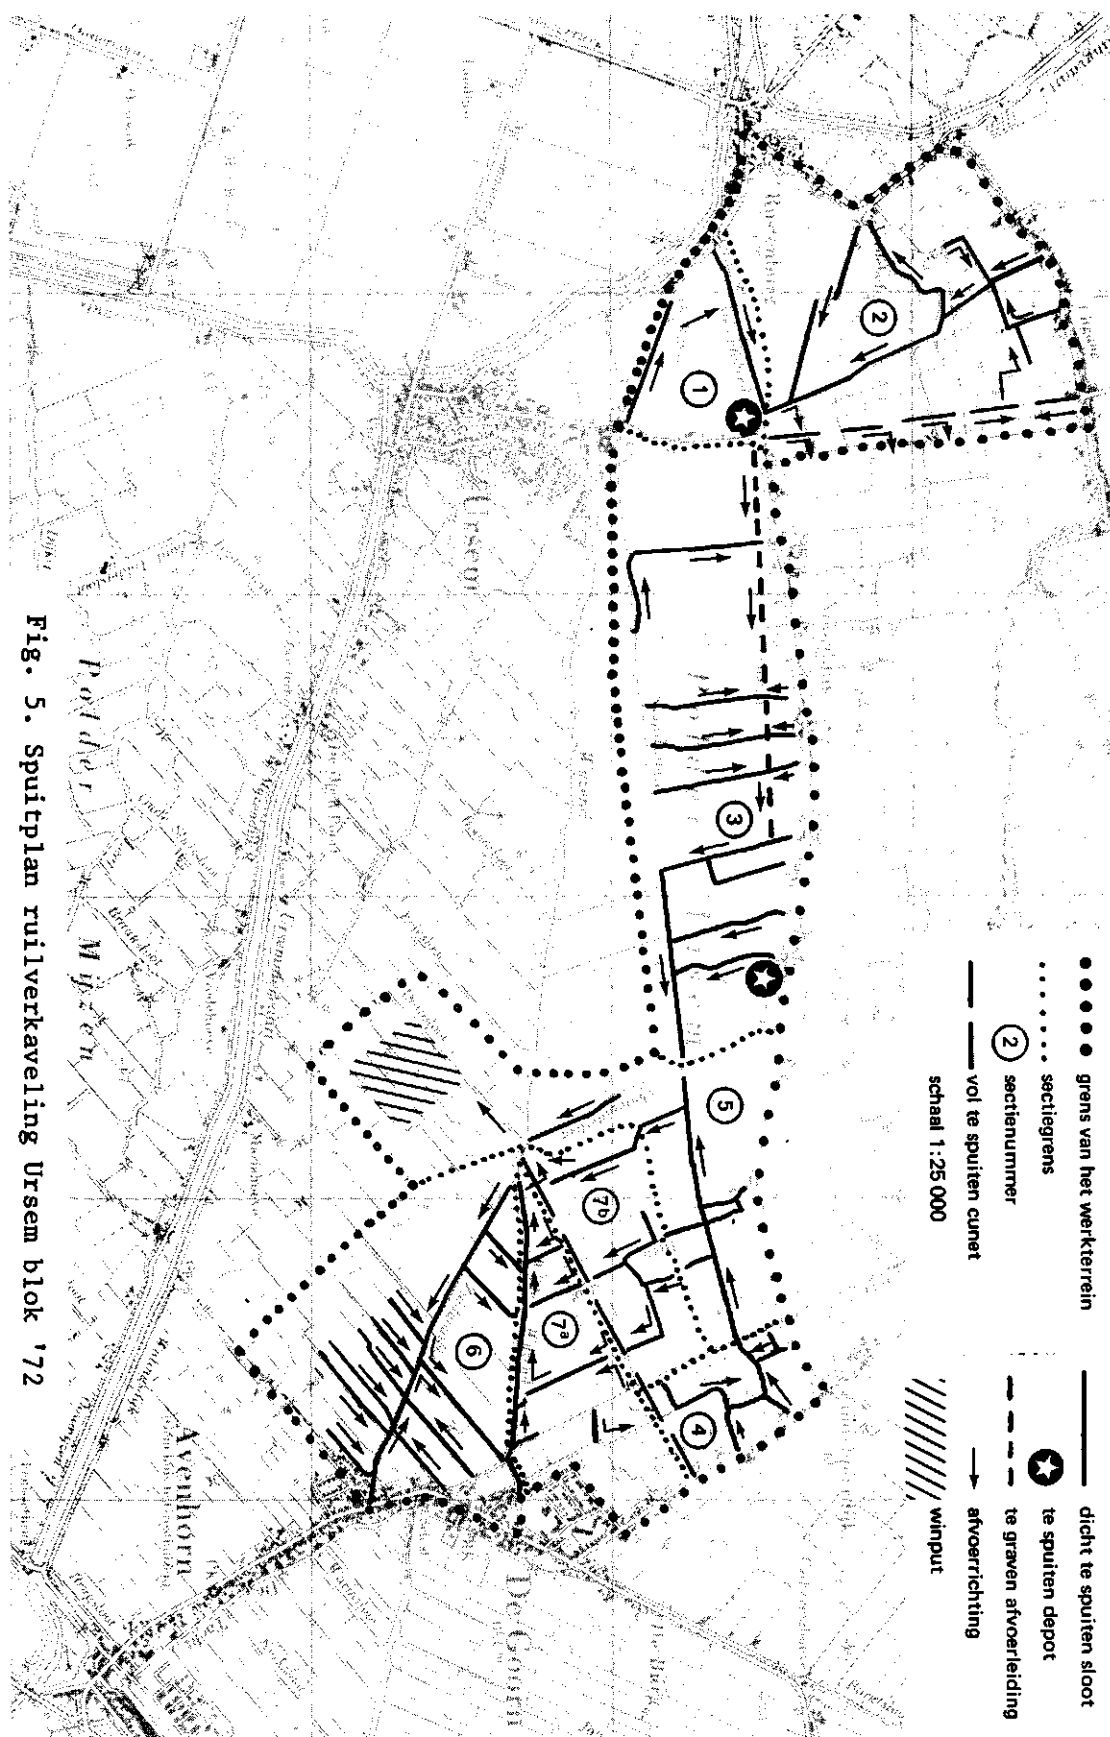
Spuitplan ruilverkaveling Ursem blok '72
